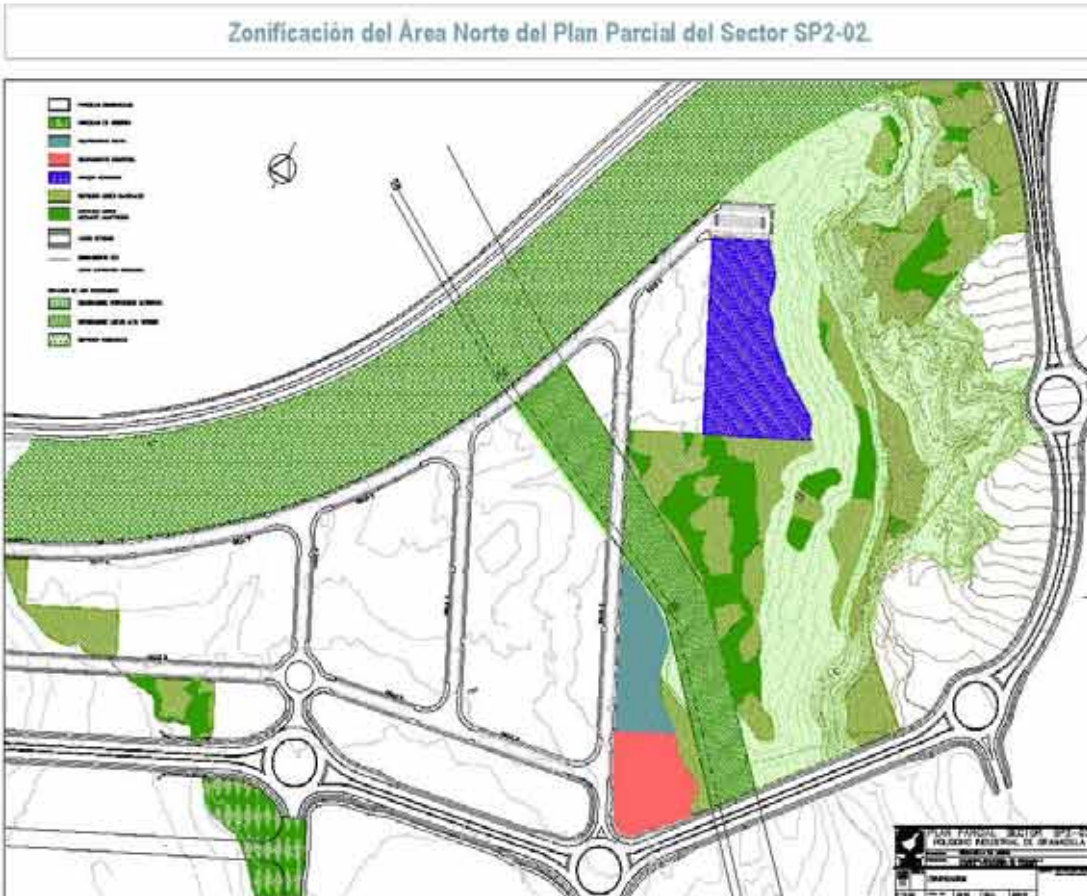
Plano de Zonificación del Suelo del Plan Parcial del Sector SP2-02. Área Norte.
